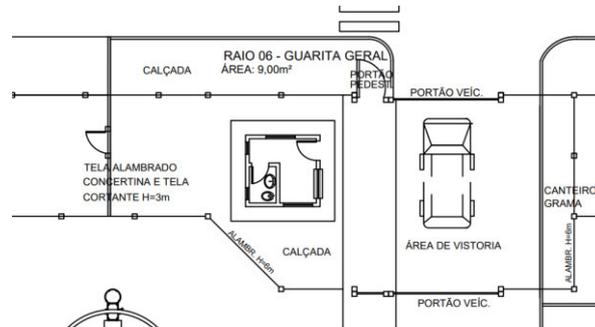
Recorte da Planta baixa da UPRF, local onde hoje se localiza a sala de triagem (BUNA, 2020)
